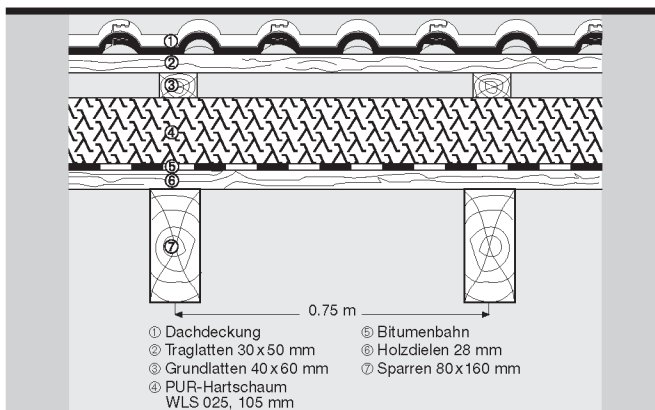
Steildachkonstruktion mit 105 mm PUR-Hartschaum (WLS 025), als Dämmung auf den Sparren, Profilholzschalung mit Luftdichtheitsschicht, sichtbare Sparren.
